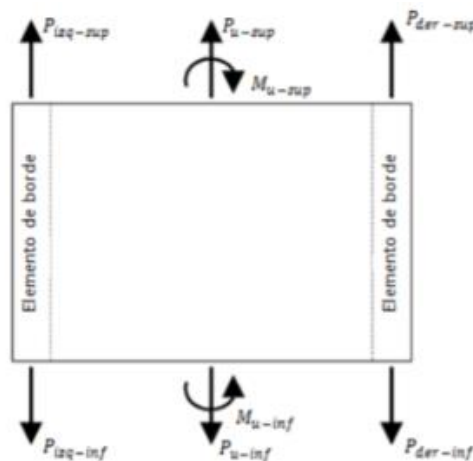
Fuerzas internas actuantes en los elementos del muro estructural
